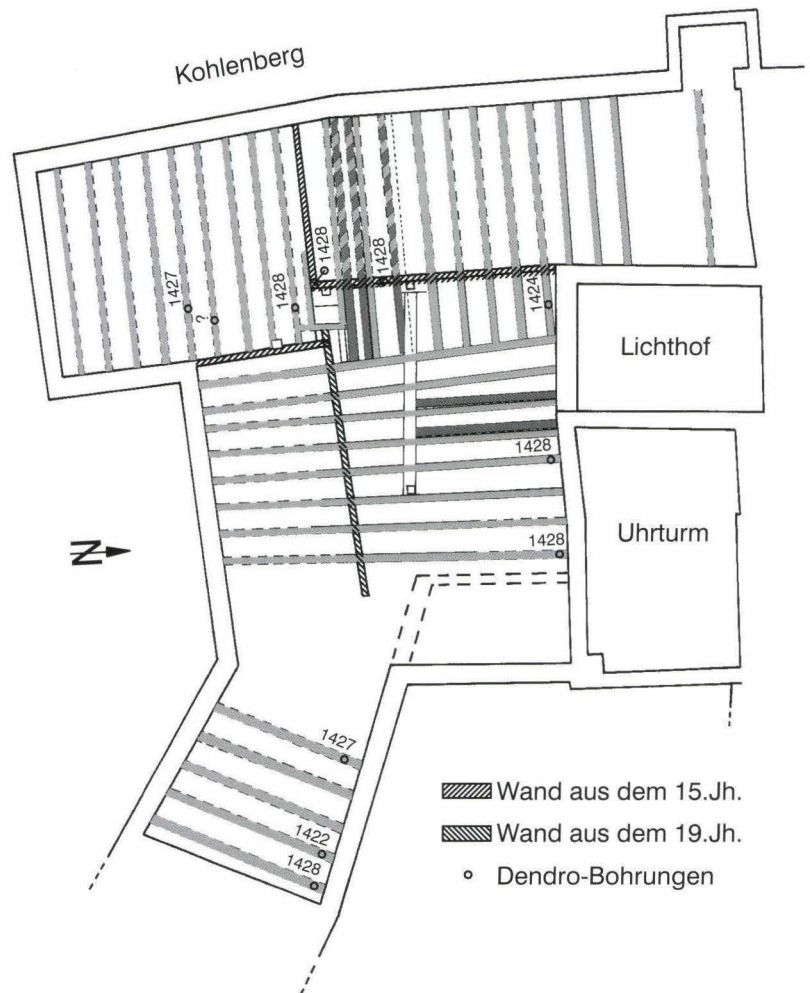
Lohnhof. Grundriss des 2. Obergeschosses mit den Balken und deren Datierungen. – Massstab 1:200. – Zeichnung: Hans Ritzmann nach Vorlage von Daniel Reicke.
